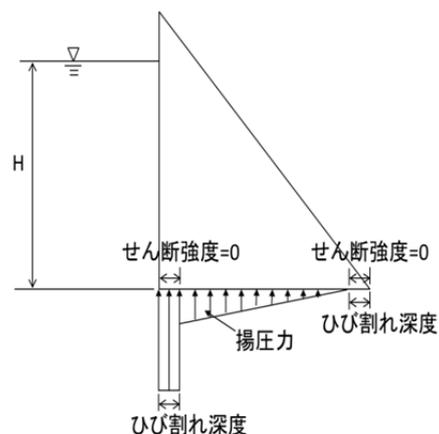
ひび割れを考慮した堤体安定性評価 (ひび割れ面に作用する揚圧力の仮定)
